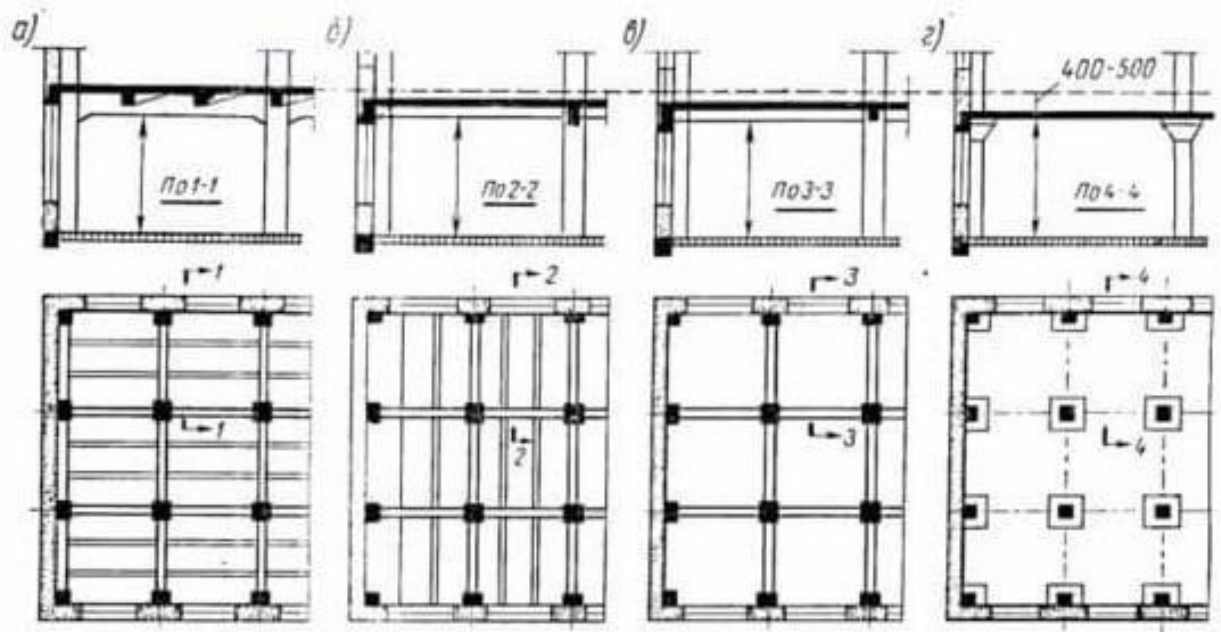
Схеми монолітних залізобетонних каркасів
